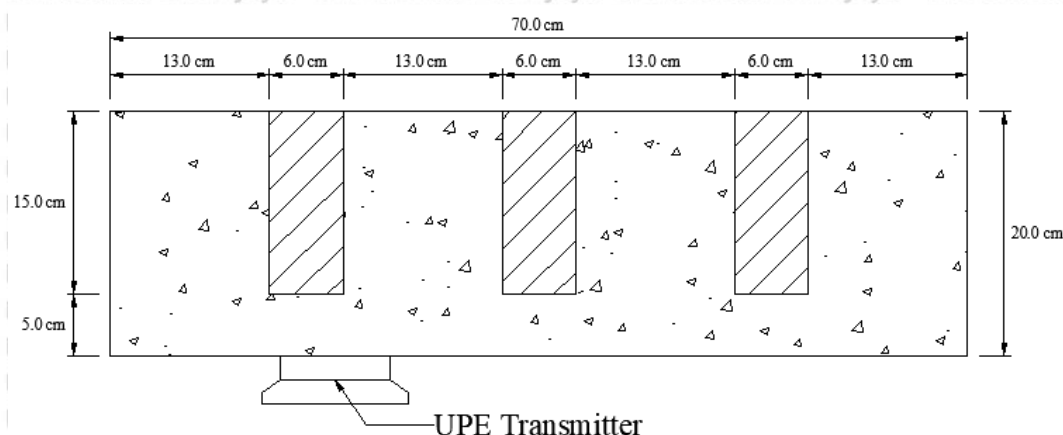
Titik pengujian b-scan beton normal dan beton dengan lubang arah transversal
